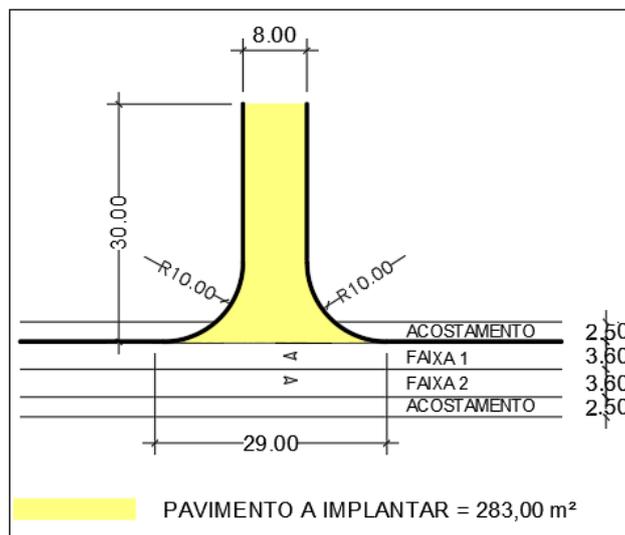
Acesso Lateral Tipo 1 (Limpa Rodas) | Geometria e Pavimentação
